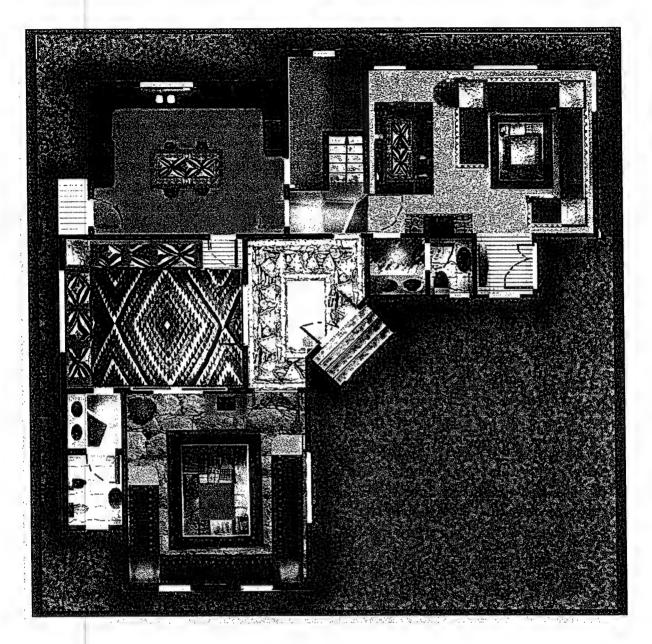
مسقط أفقي للدور الأرضي (نموذج ١)
